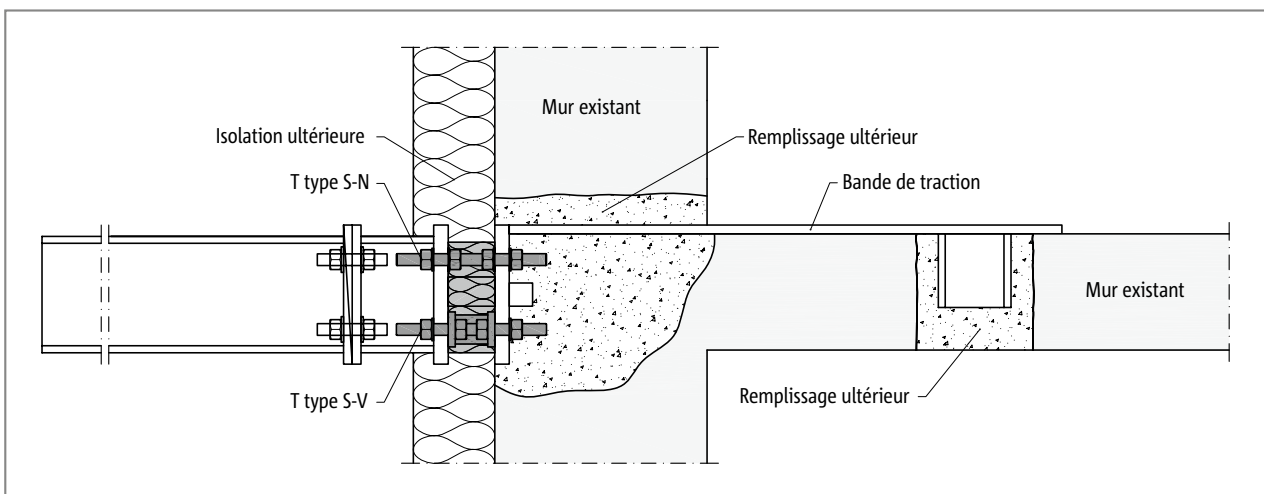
Schöck Isokorb® T type S-N et T type S-V : balcon en acier avec adaptateur, en porte-à-faux, posé ultérieurement ; relié à la dalle en béton armé existante par une bande de traction
